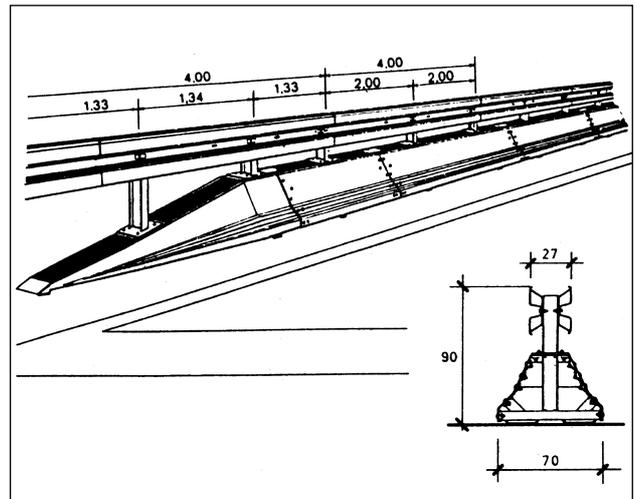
sistema di barriera di sicurezza in acciaio Vecu-Sec
